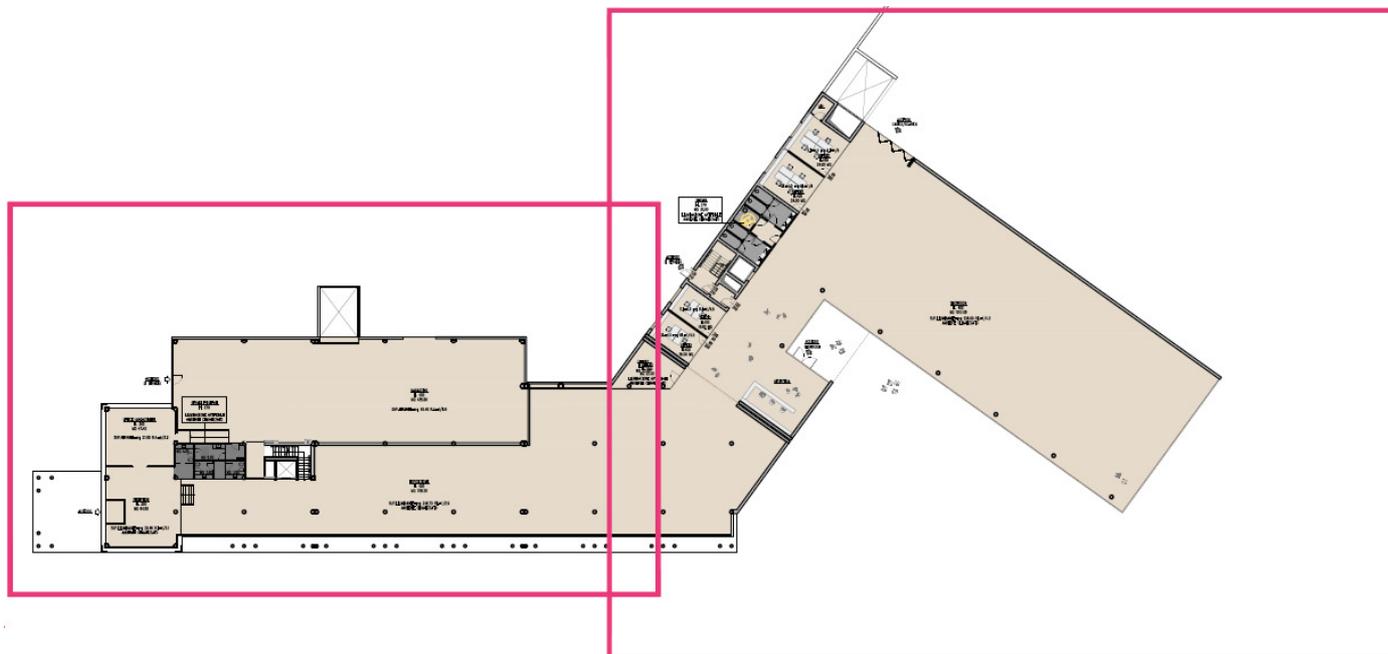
estratto Planimetria di progetto A4.03 piano primo
